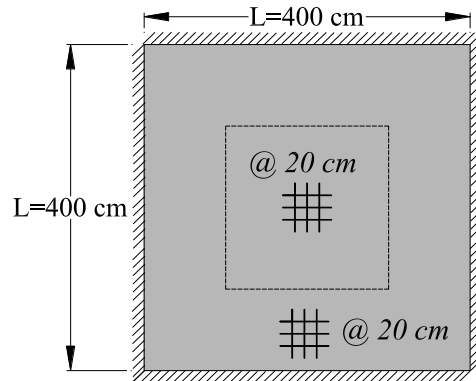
Vista en planta de la losa cuadrada empotrada.
